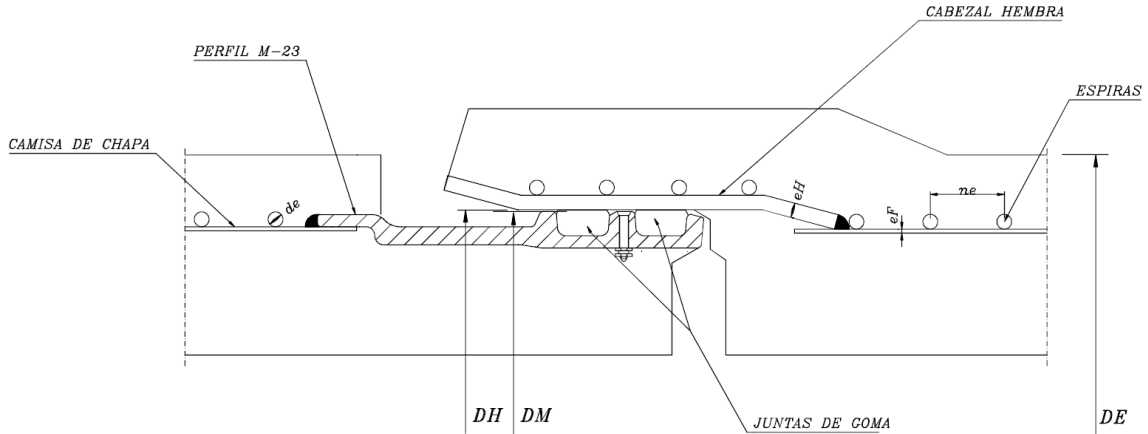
Junta elástica doble en tubería de hormigón postesado con camisa de chapa.
